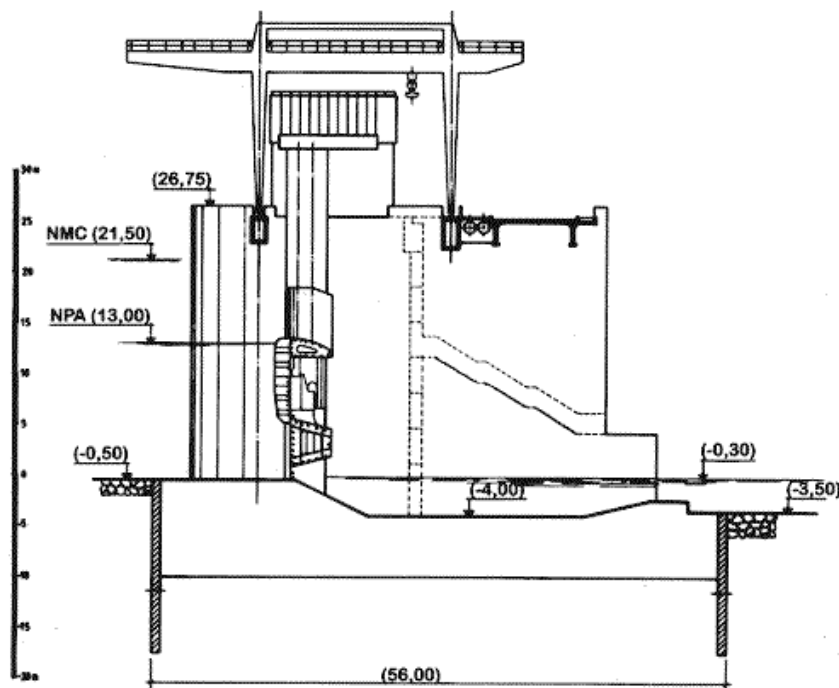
Corte transversal da barragem de Crestuma-Lever [5]
